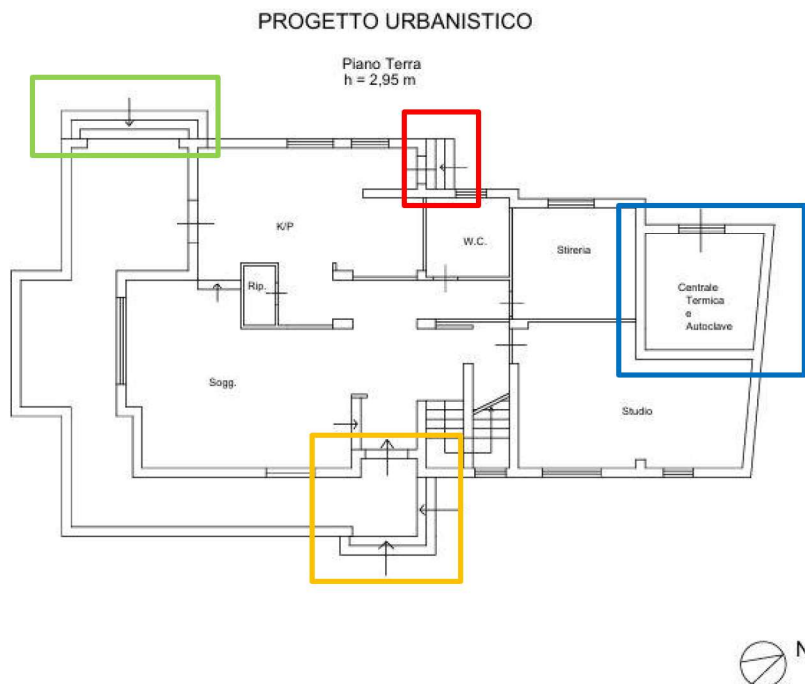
Planimetria Sub 7 Piano T Progetto Urbanistico
